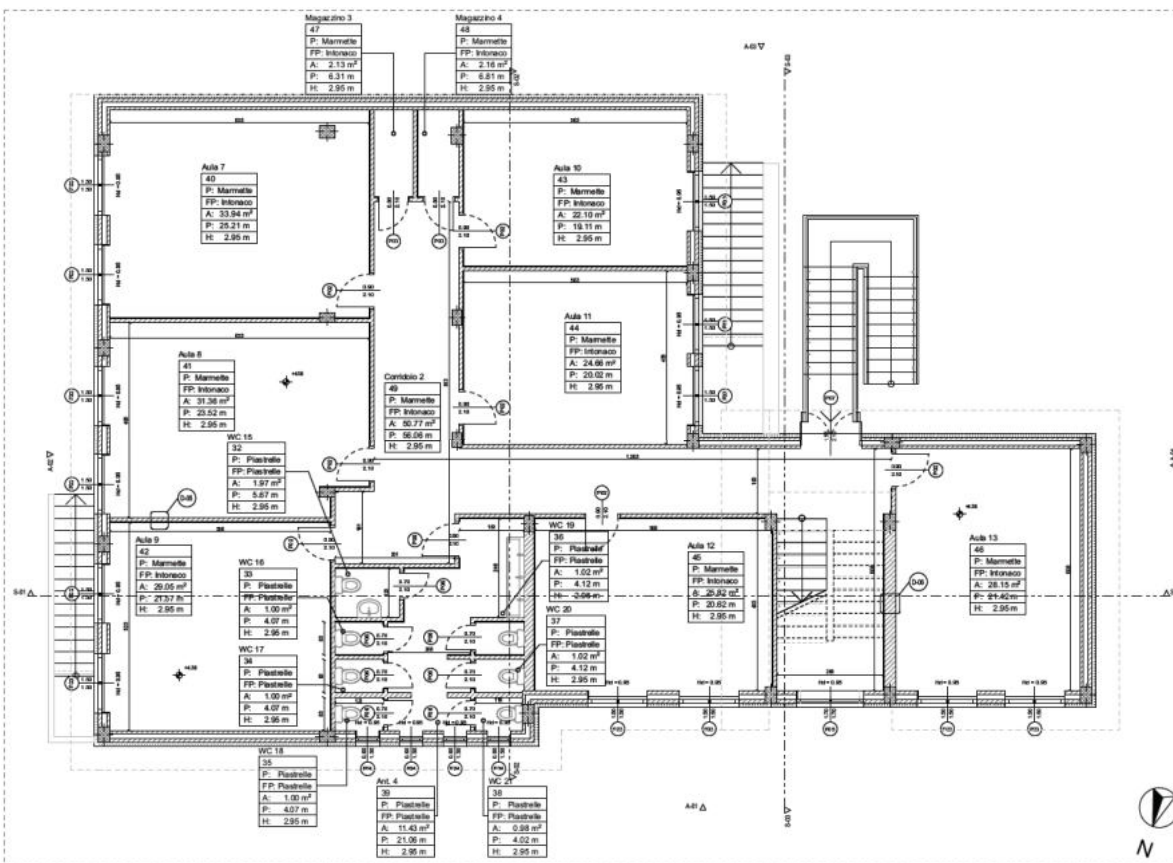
Stato dei luoghi. Pianta Piano Primo.
